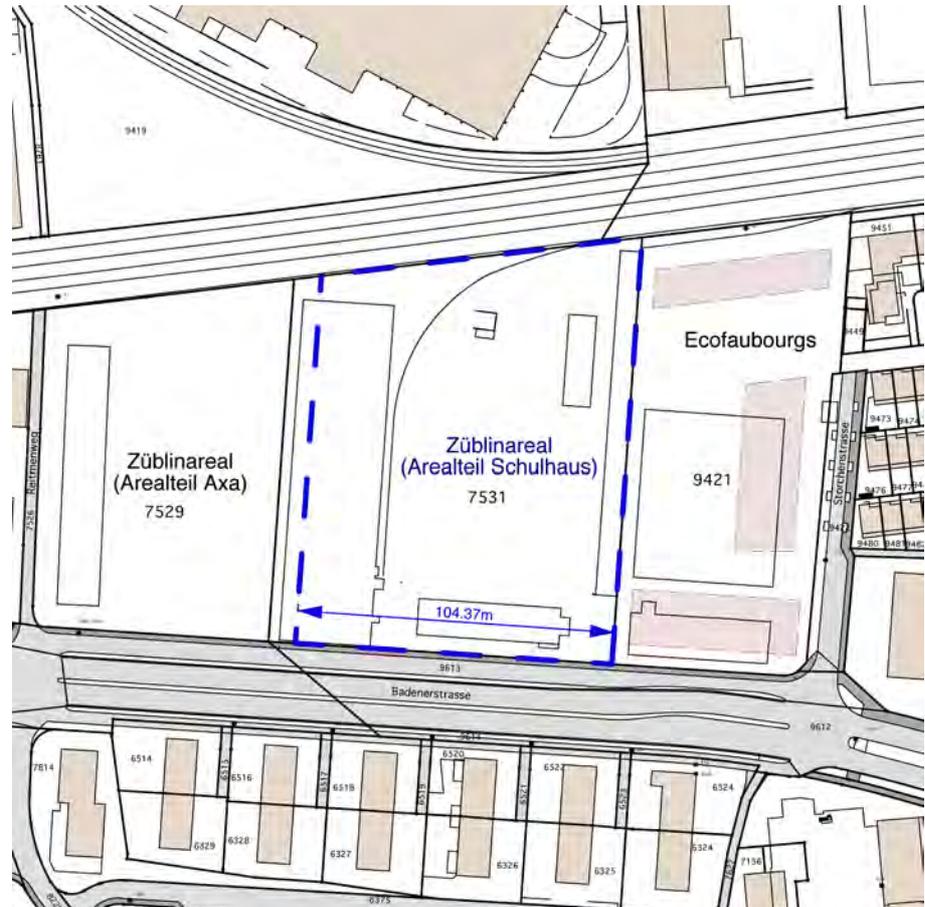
Planungsgebiet mit Perimeter Schulhaus Schlieren West
